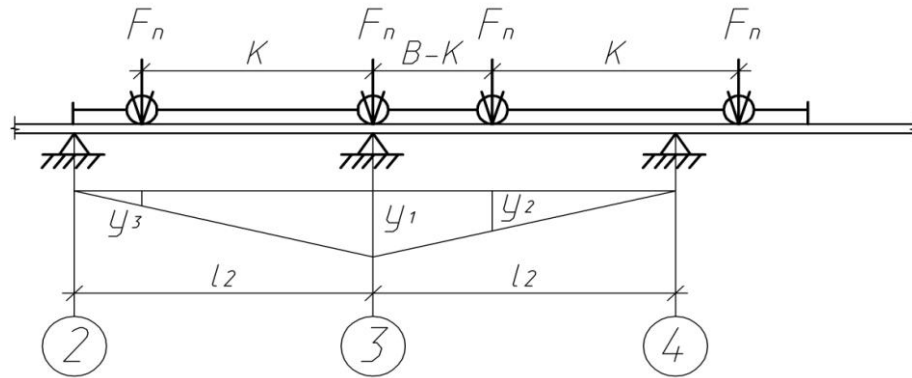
Расчетная схема к определению крановой нагрузки
